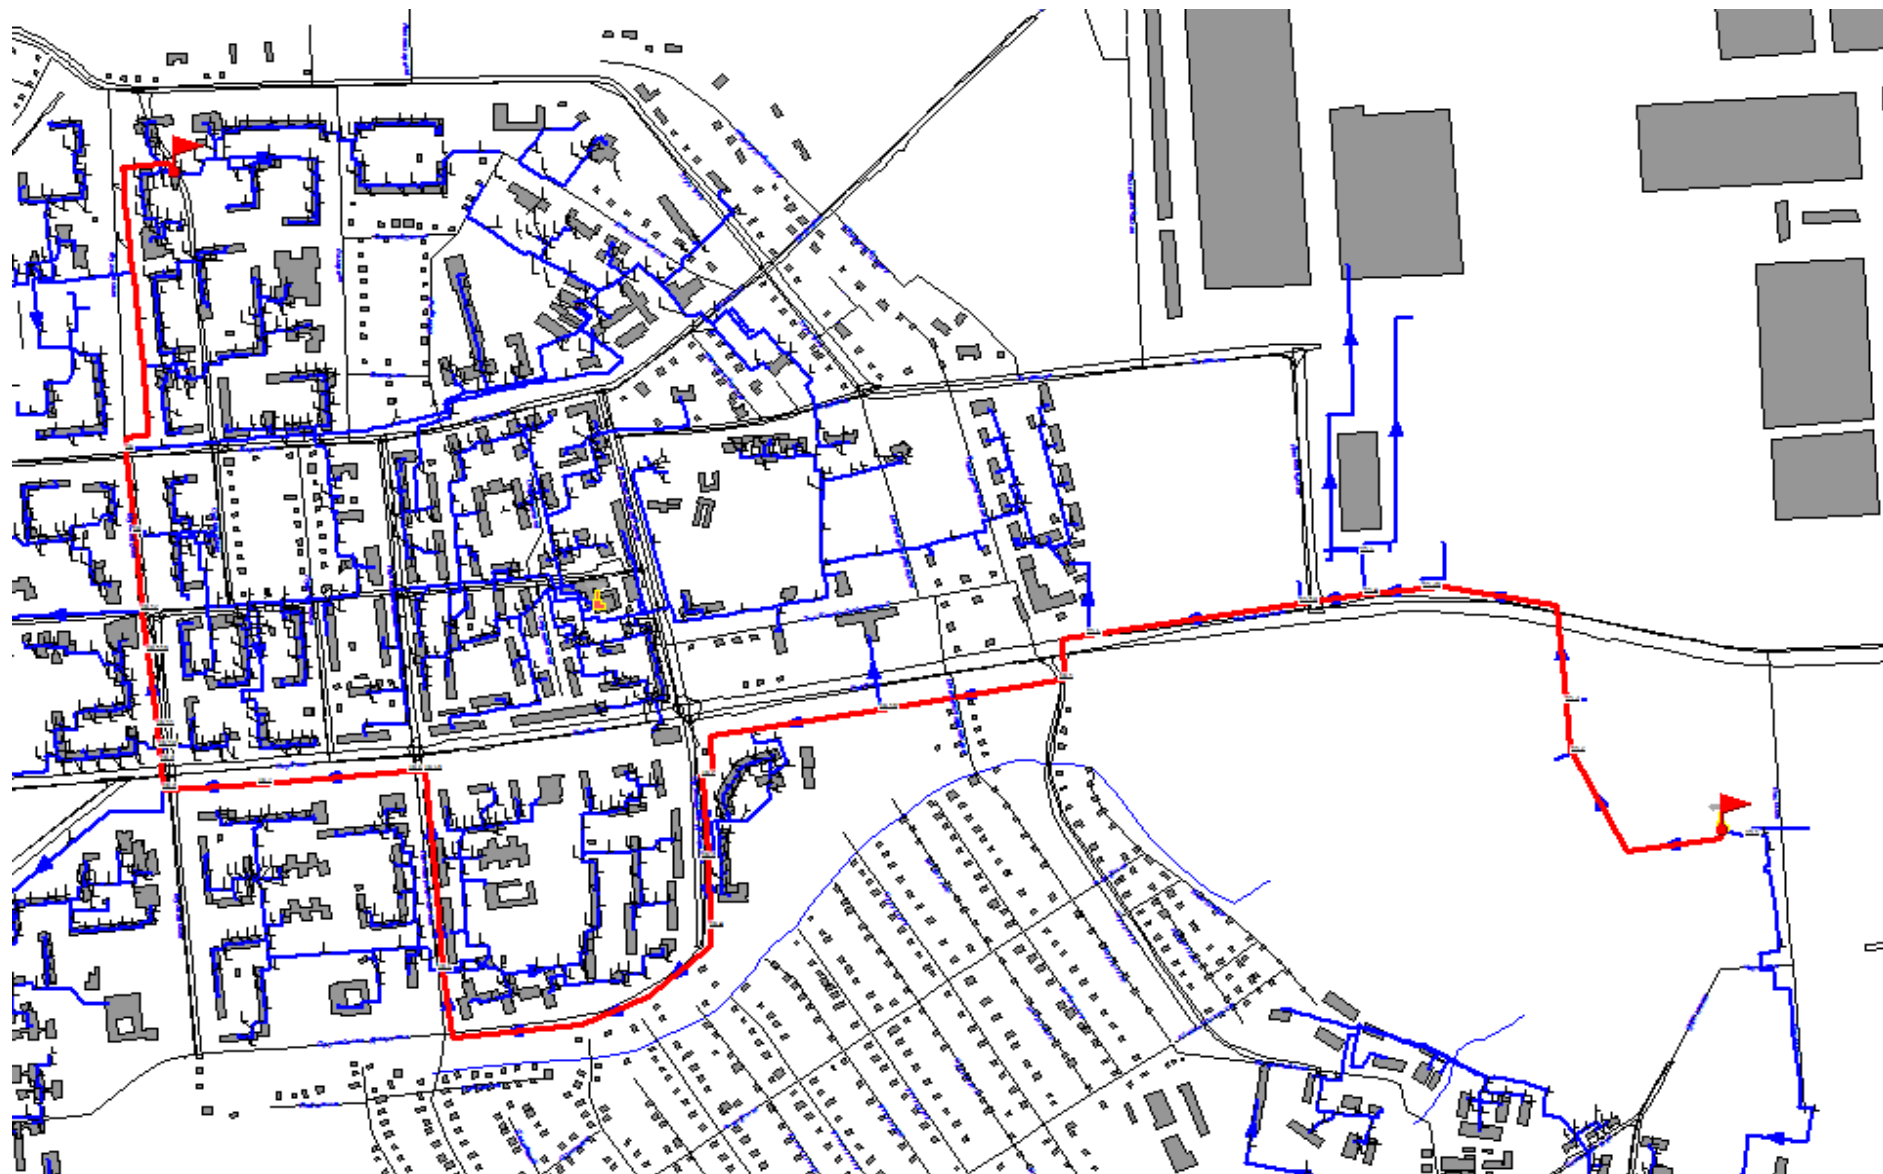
Расчетная схема участка тепловой сети от котельной 13-й улицы ООО «РТК» до ЦТП-6/1
